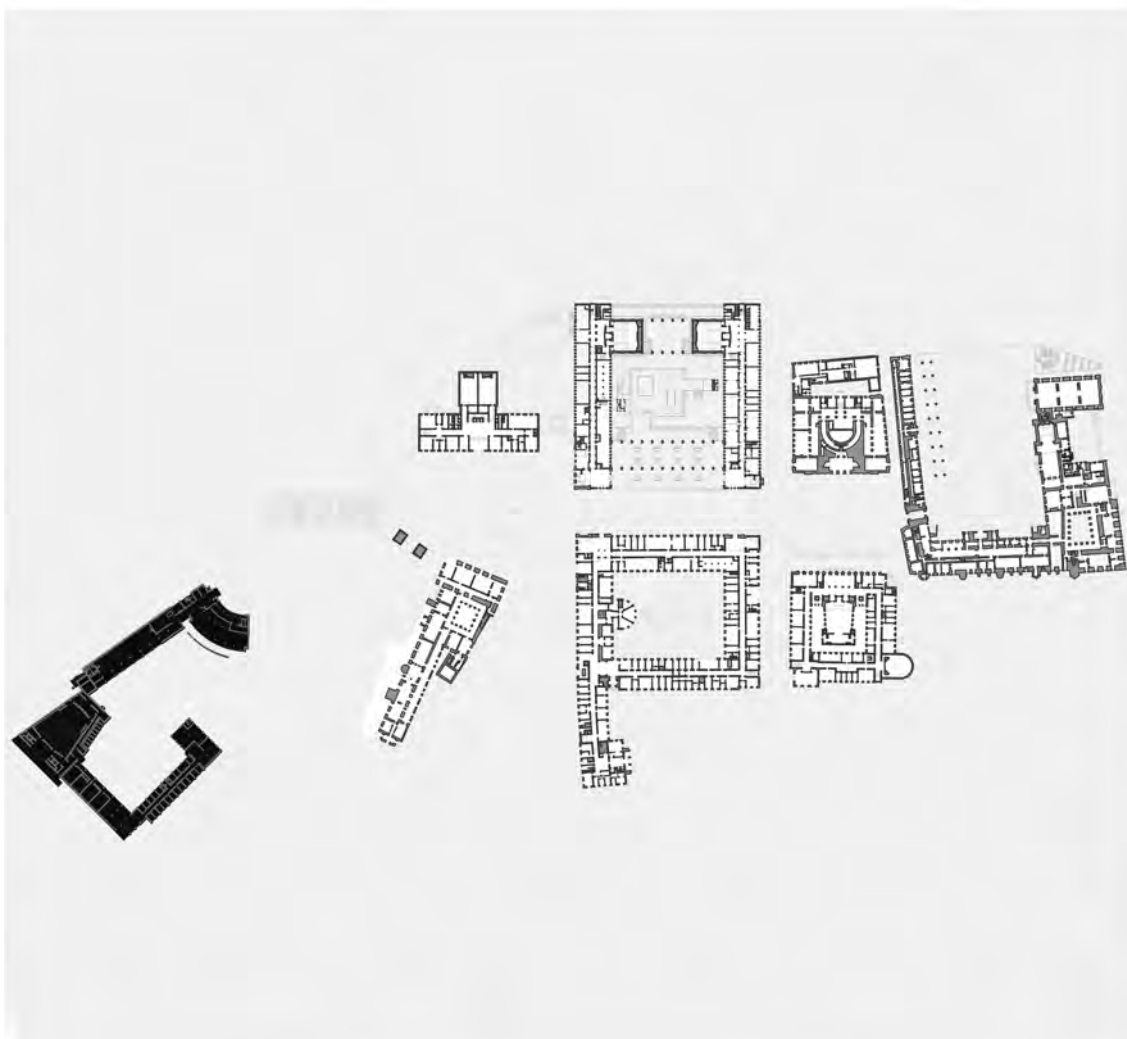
e 30 - Perfil e planta de localização das Instalações Académicas de Coimbra
